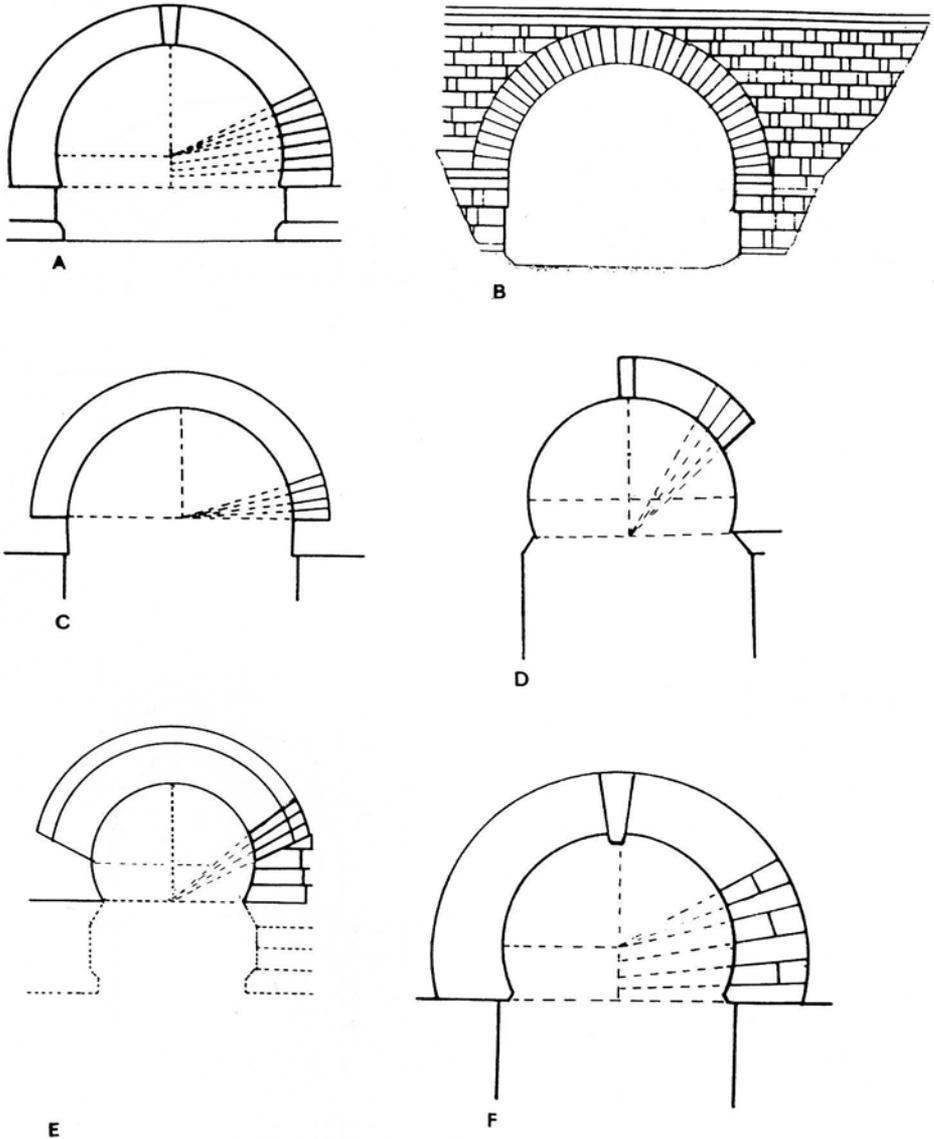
a) esquema del puente de Cantarranas b) puente de Cantarranas según Pavón Maldonado, c) esquema constructivo del puente de Cantarranas, según Pavón Maldonado, d) esquema del trazado del puente del Bembezar, e) esquema de la restitución arco del de herradura empleado en el puente de los Nogales, f) esquema del arco de la Puerta de Sevilla.
